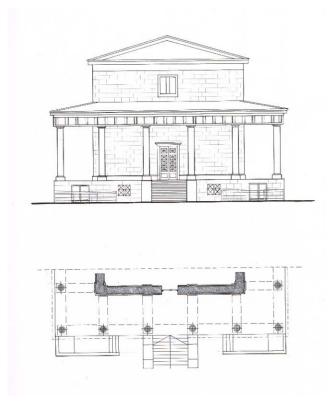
, Fachada y planta del Gimnasio del Colegio Nacional o Partenón de la UNLP, Trabajo en tinta sobre papel blanco
